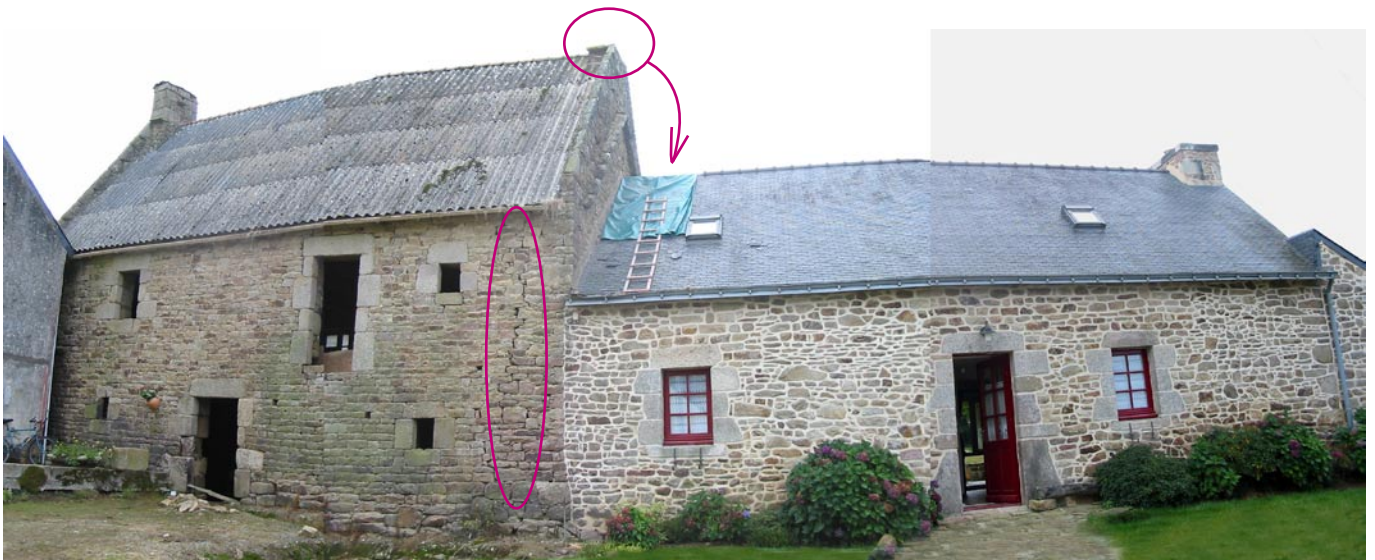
cheminée cassée au ras du toit (Kerhen-Liven, Languidic).
